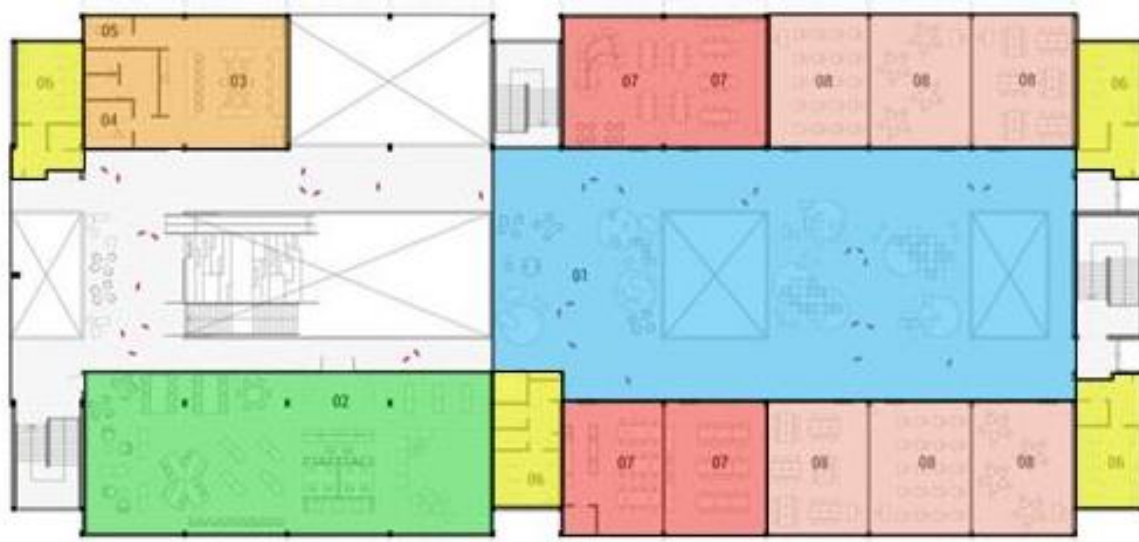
Setorização pavimento térreo do Colégio Marista e modificado pela autora
